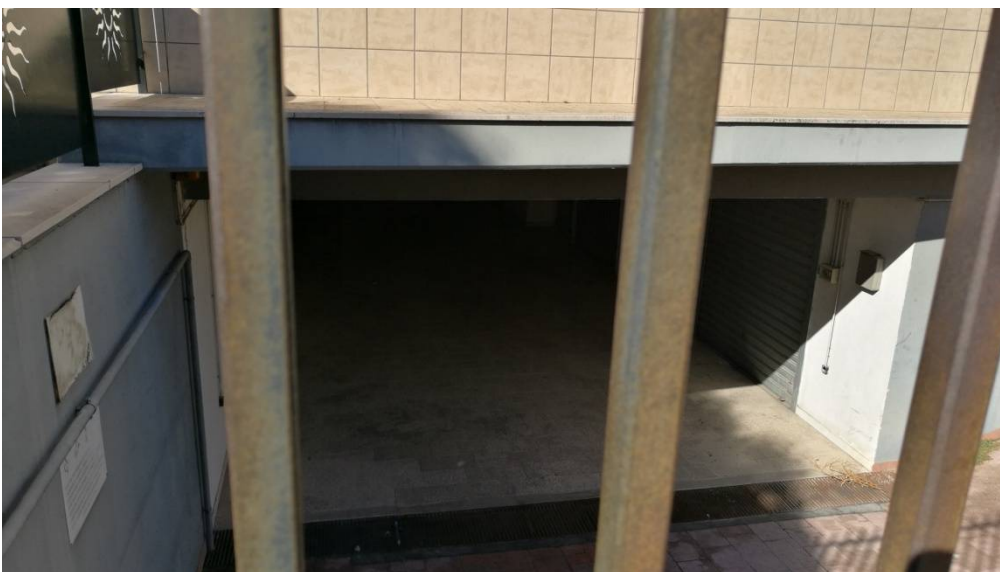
Vista dall'alto dell'ingresso al corridoio di manovra
